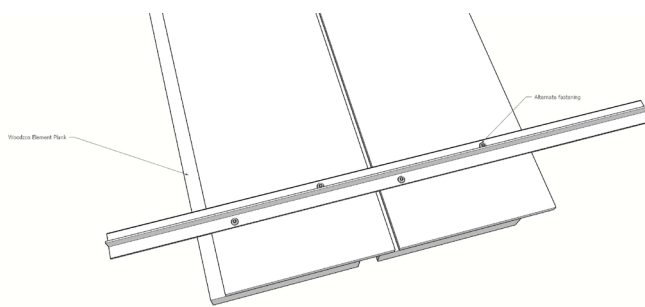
Fixation directe d'une planche ELEMENT avec des vis sur un système de suspension.
